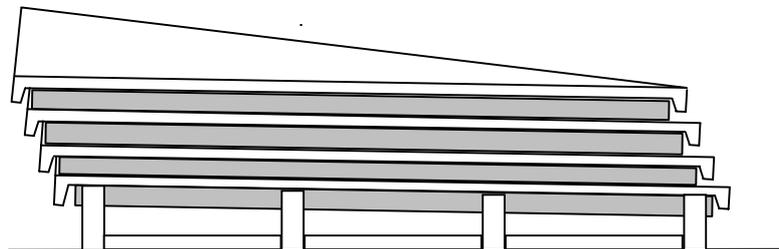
Corte longitudinal esquemático do empilhamento das peças
